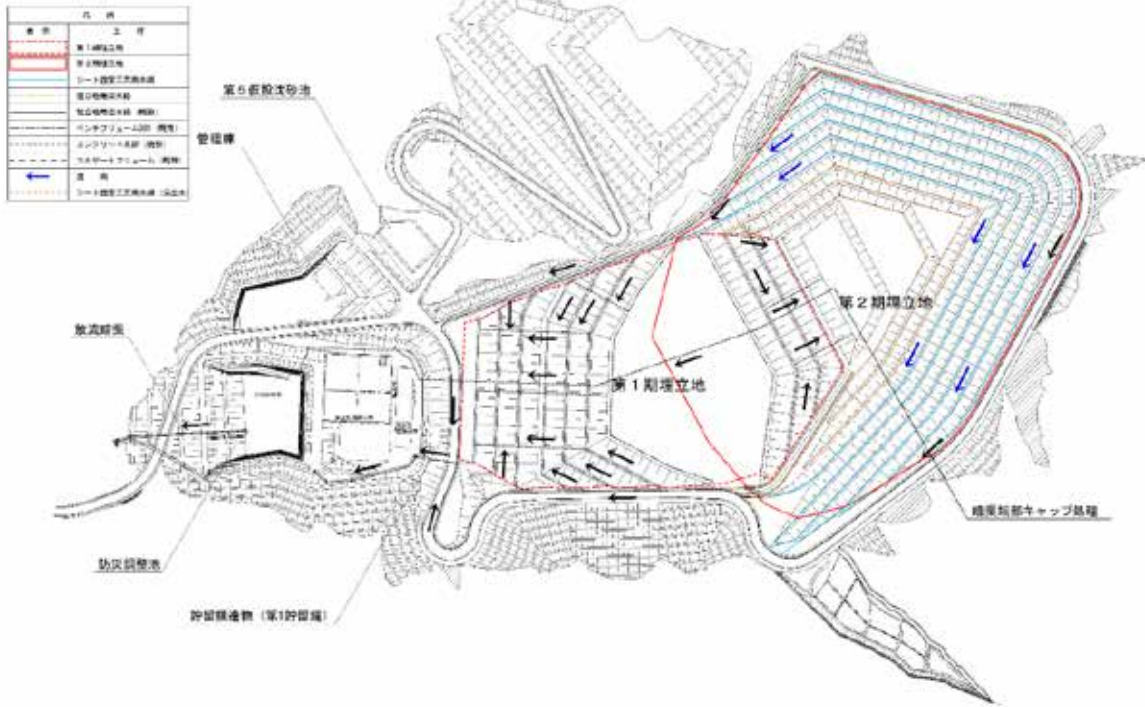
雨水集排水設備配置図 第2期埋立開始時
